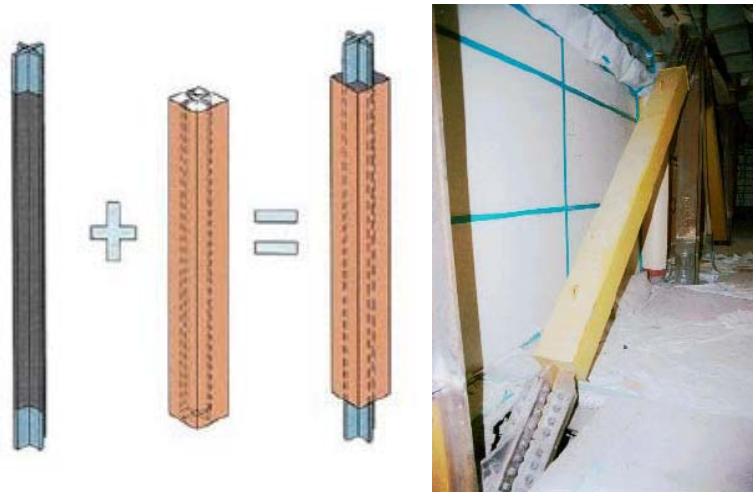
Configuración de las barras de pandeo restringido (BRB)
